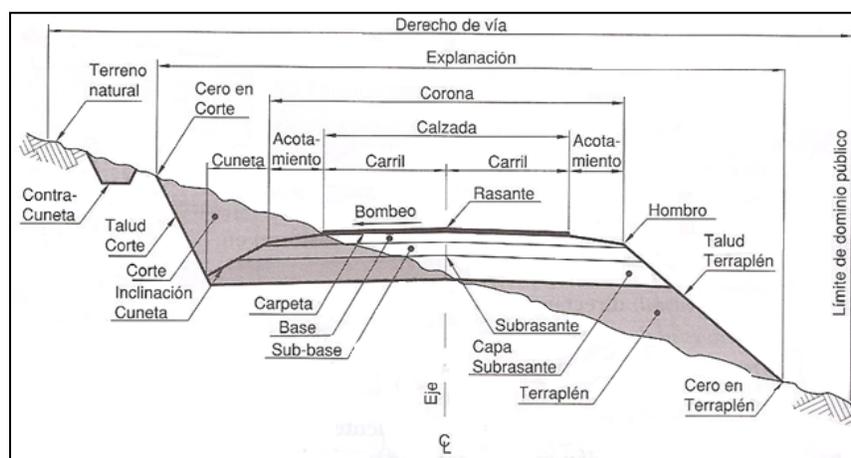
Sección transversal típica mixta, pavimentada en recta. Fuente: (Cal y Mayor & Cárdenas, 2007).
